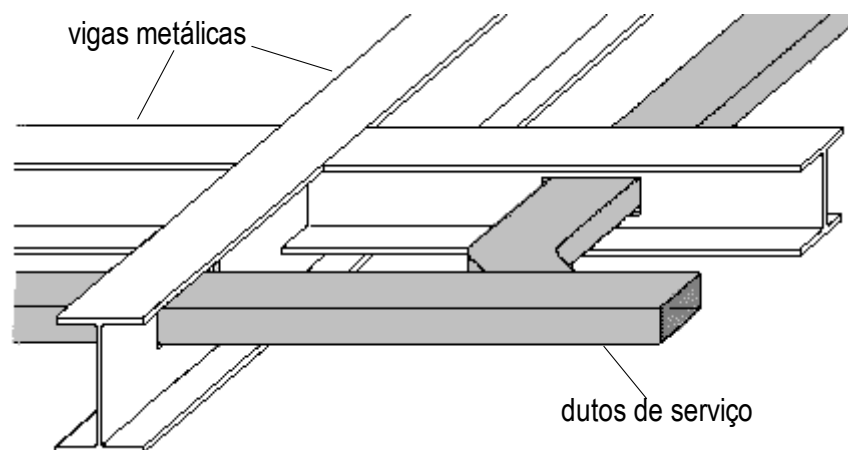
Vigas Metálicas com Aberturas na Alma
